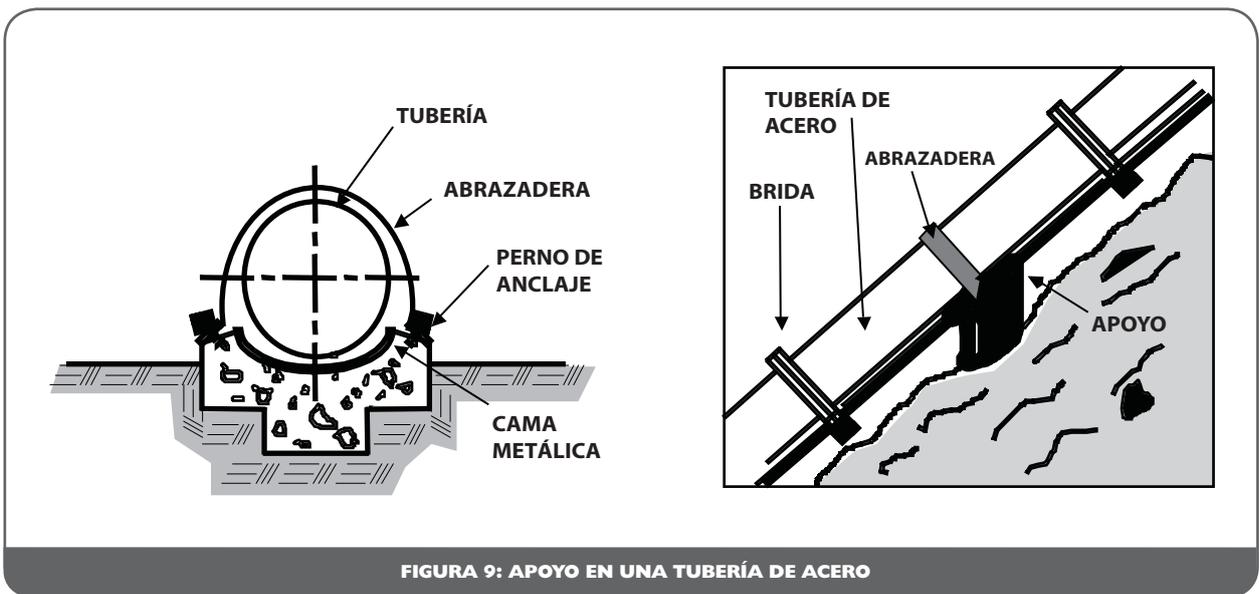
APOYO EN UNA TUBERÍA DE ACERO
